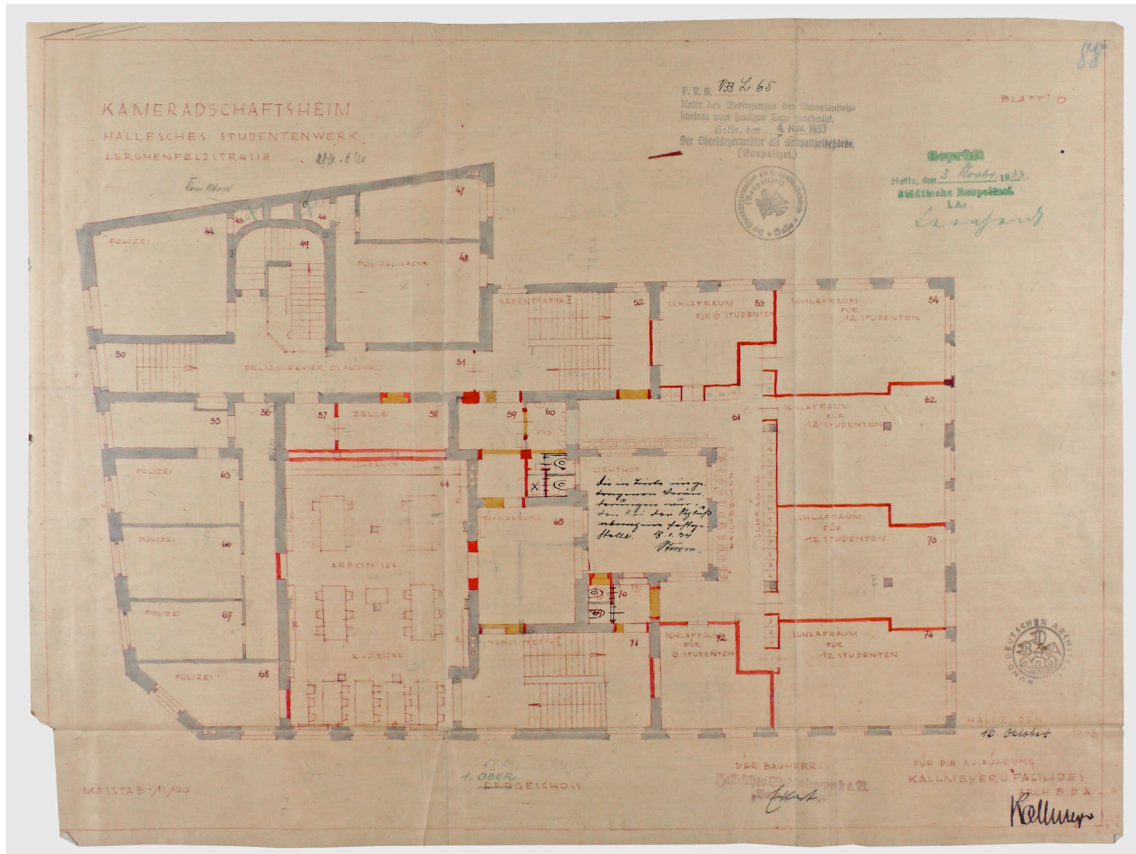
Gebäude in der Lerchenfeldstraße 14 in Halle, Grundriss Erdgeschoss, datiert 16. Oktober 1933.
